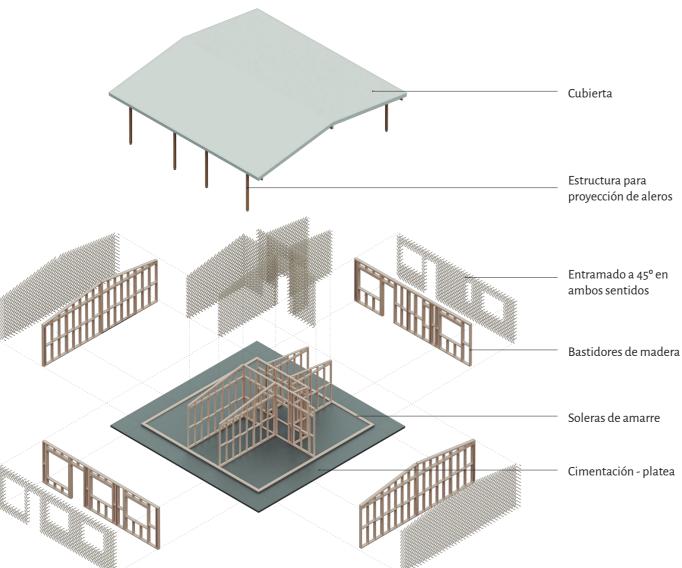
Montaje de paneles. Fuente: Ñandé, 2021.
